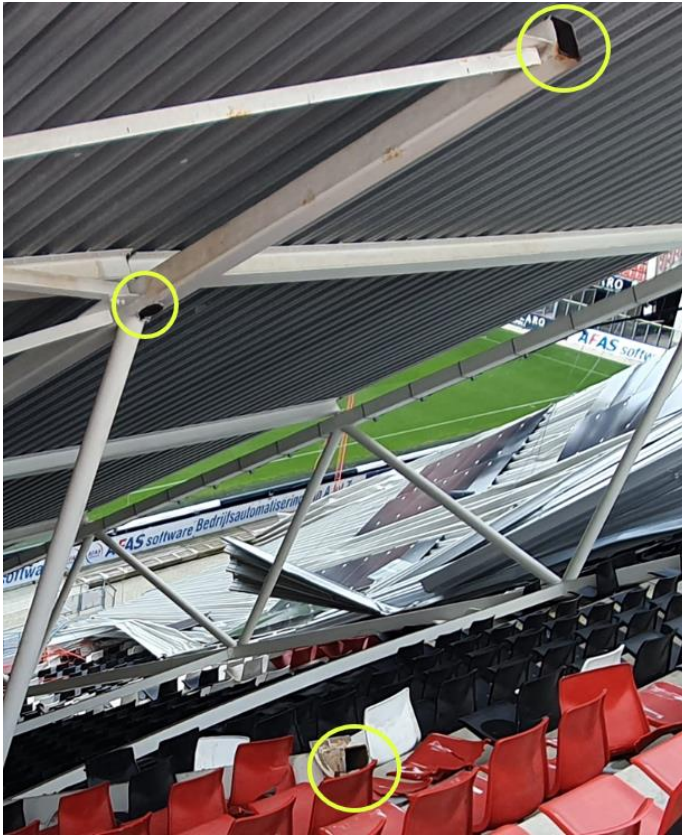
Detailfoto van aansluiting van boven- en onderregel op kopplaten bij vakwerkligger 36
